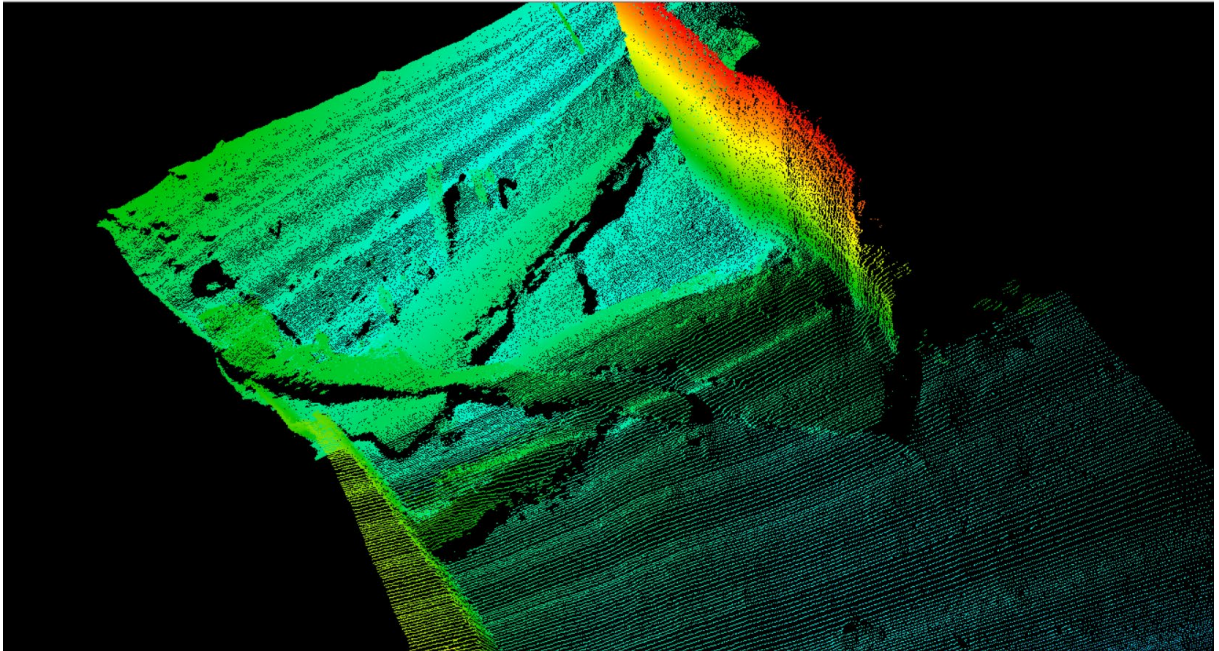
Vigas y tablero del vano P5-P6 colapsados entre ambas pilas.
